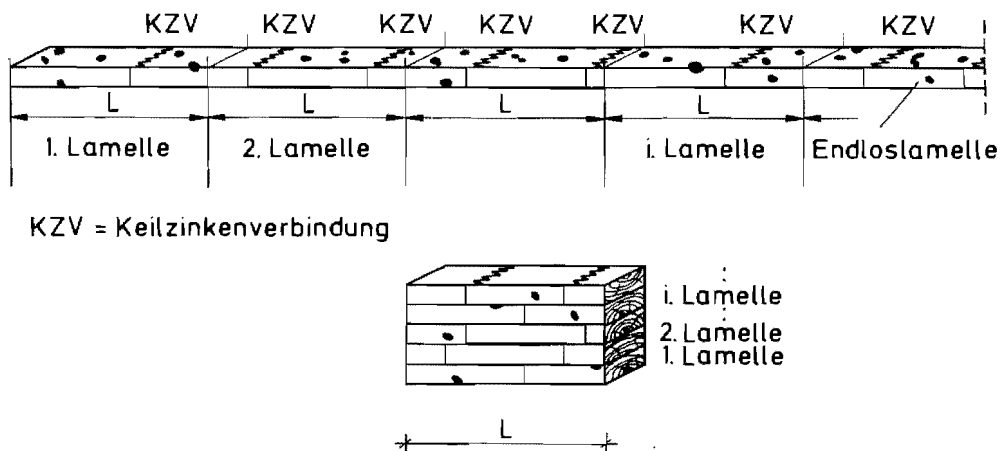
Prinzip des Aufbaues eines Brettschichtholzträgers aus einer Endloslamelle
